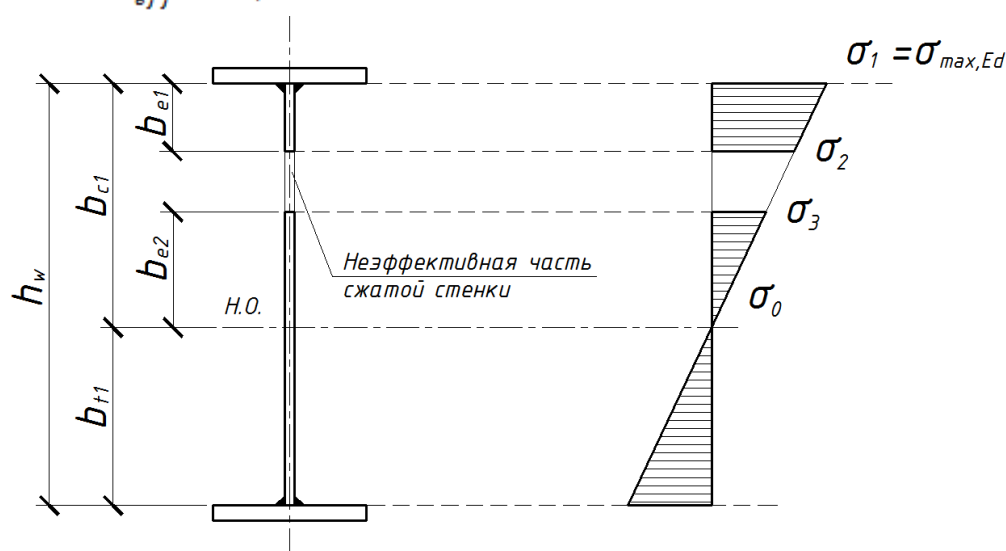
Эпюра напряжений в стенке сварной балки
